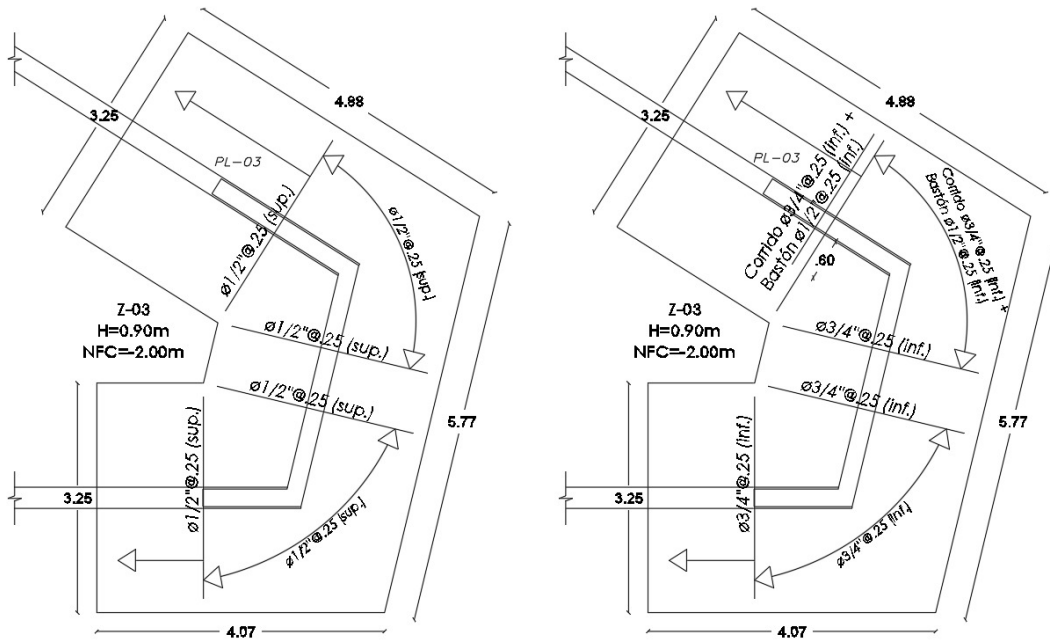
Disposición final de refuerzo transversal en zapata Z-03
